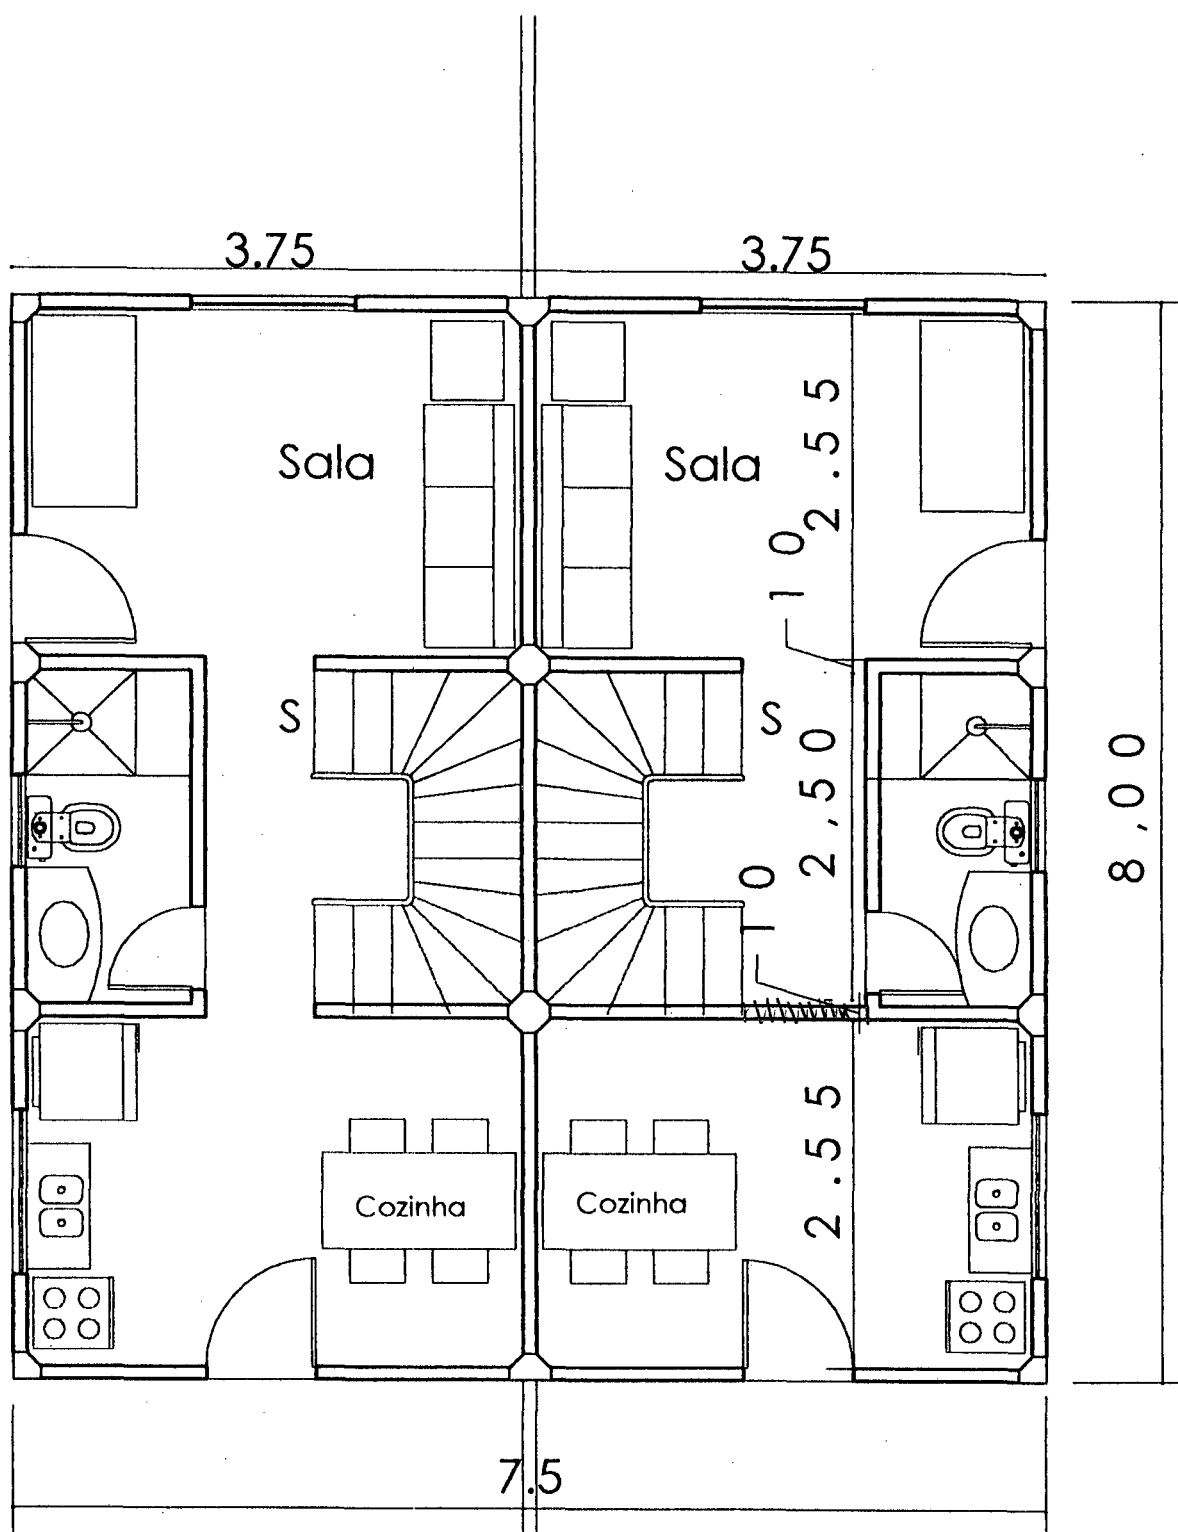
Planta da Residência Geminada: Pavimento Térreo.
